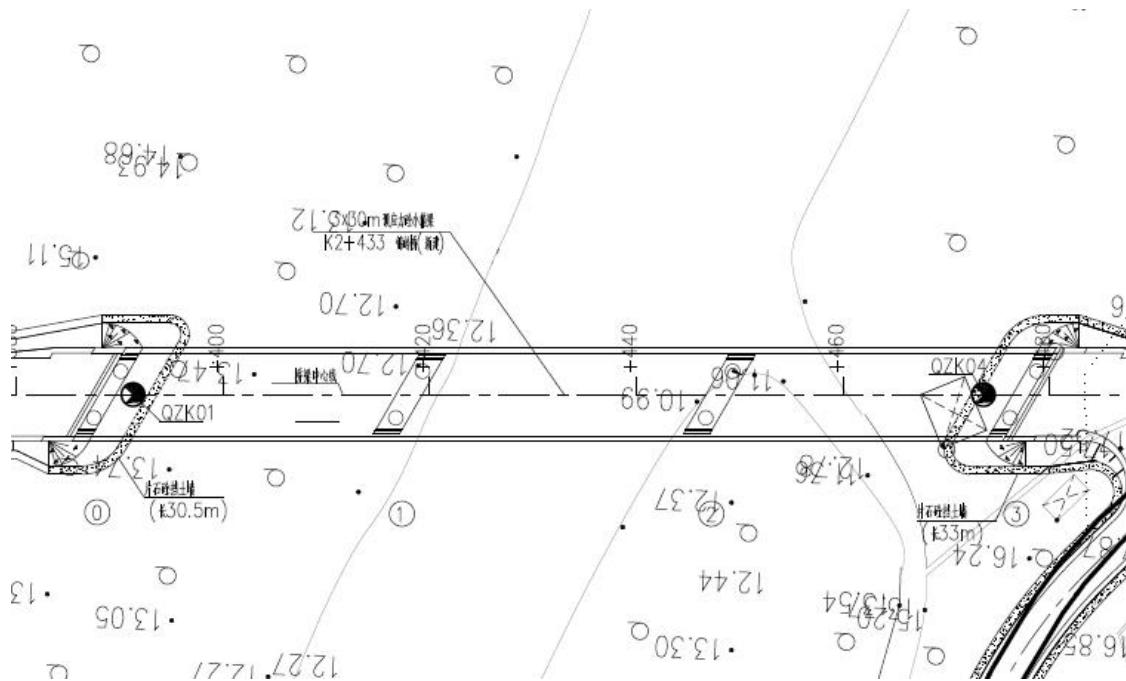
桥梁工程布置平面与现状岸坡评平面关系图
